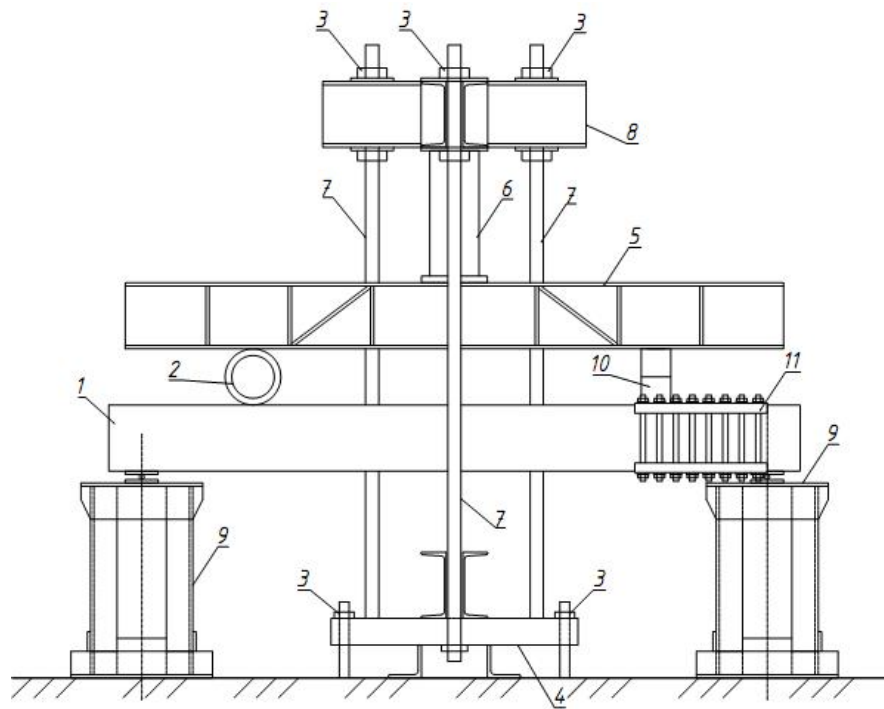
Стенд для випробовування одного похилого перерізу в залізобетонних балках
